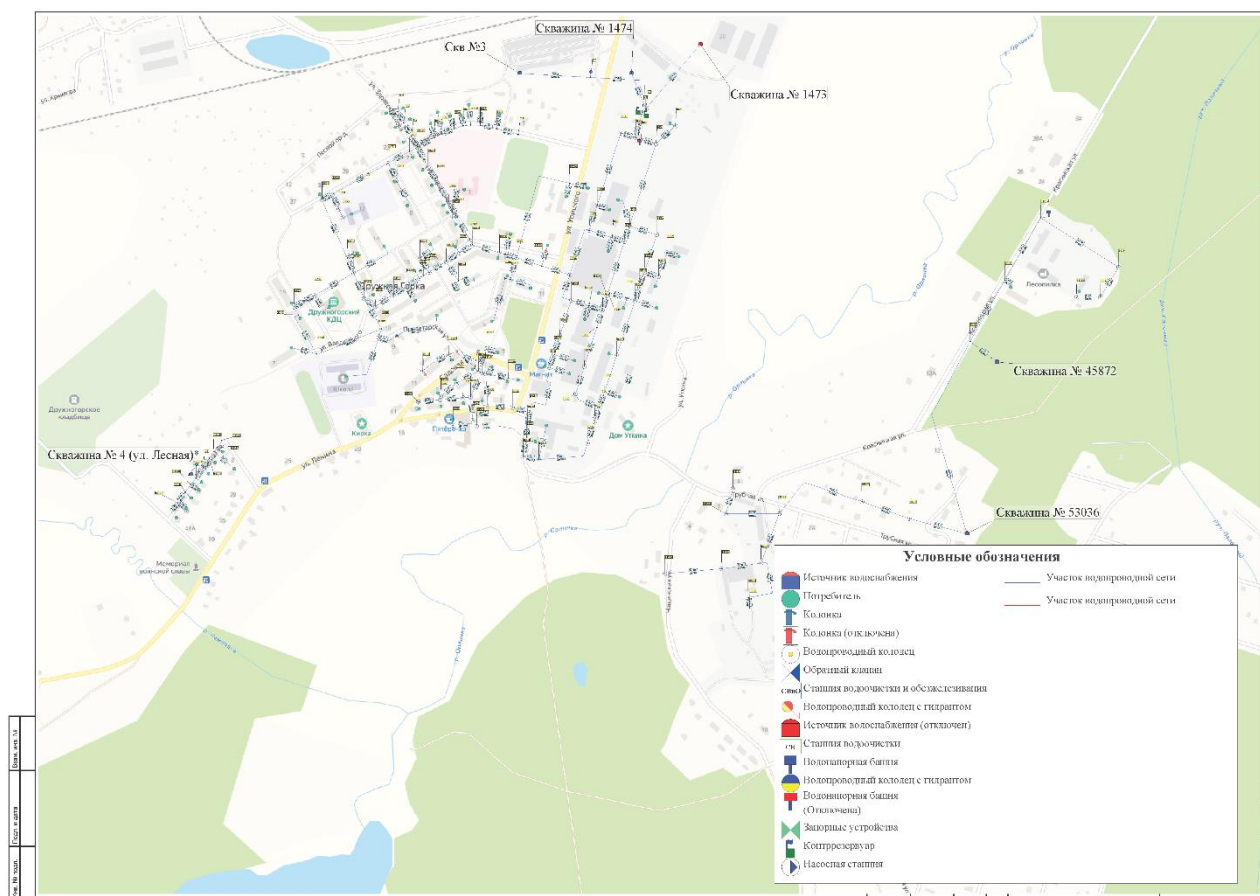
Схема водопроводных сетей системы водоснабжения гп. Дружная Горка
